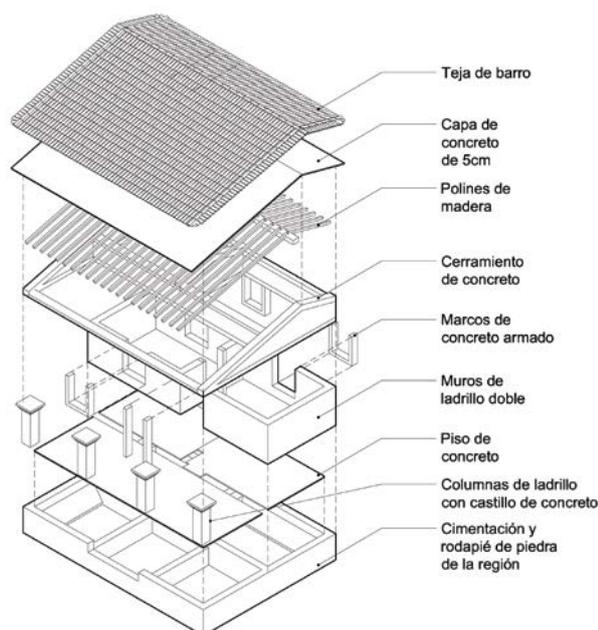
Despiece de la Vivienda tradicional Istmeña. Fuente: Elaboración propia.
